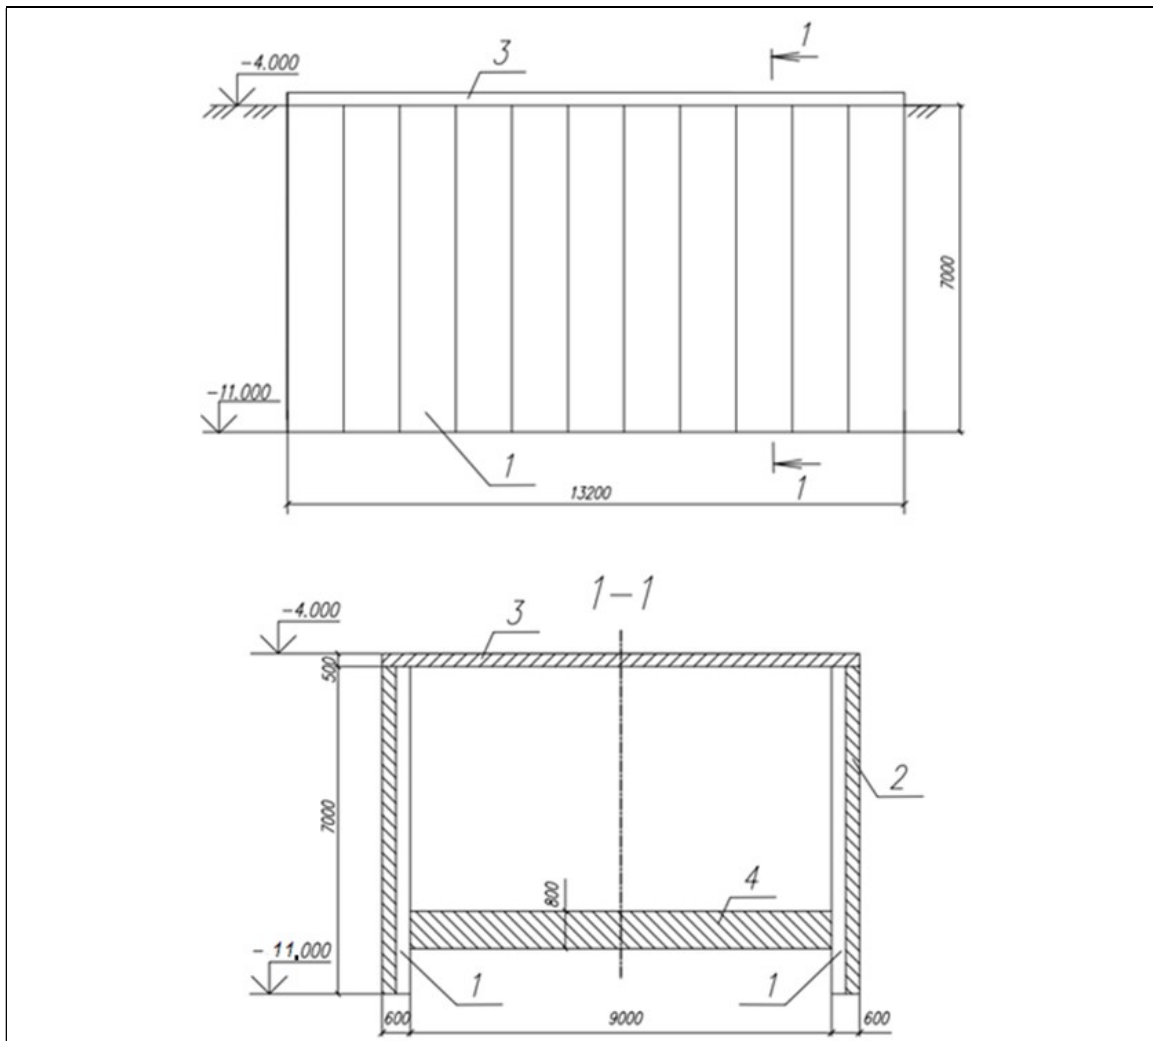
Монтажная схема стеновых панелей в горизонтальном тоннеле: 1 – стеновая панель с арматурными выпусками; 2 – монолитная часть «стены в грунте»; 3 – перекрытие тоннеля; 4 – днище тоннеля
